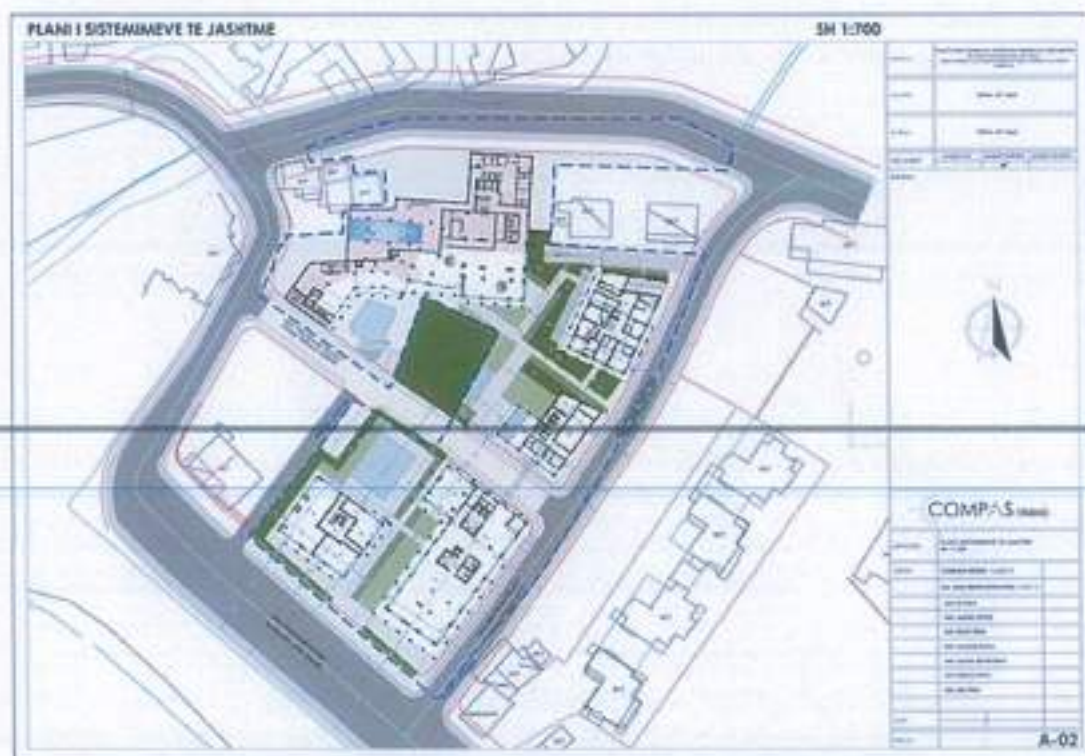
Plani i hapësirave të jashtme të objektit të propozuar
